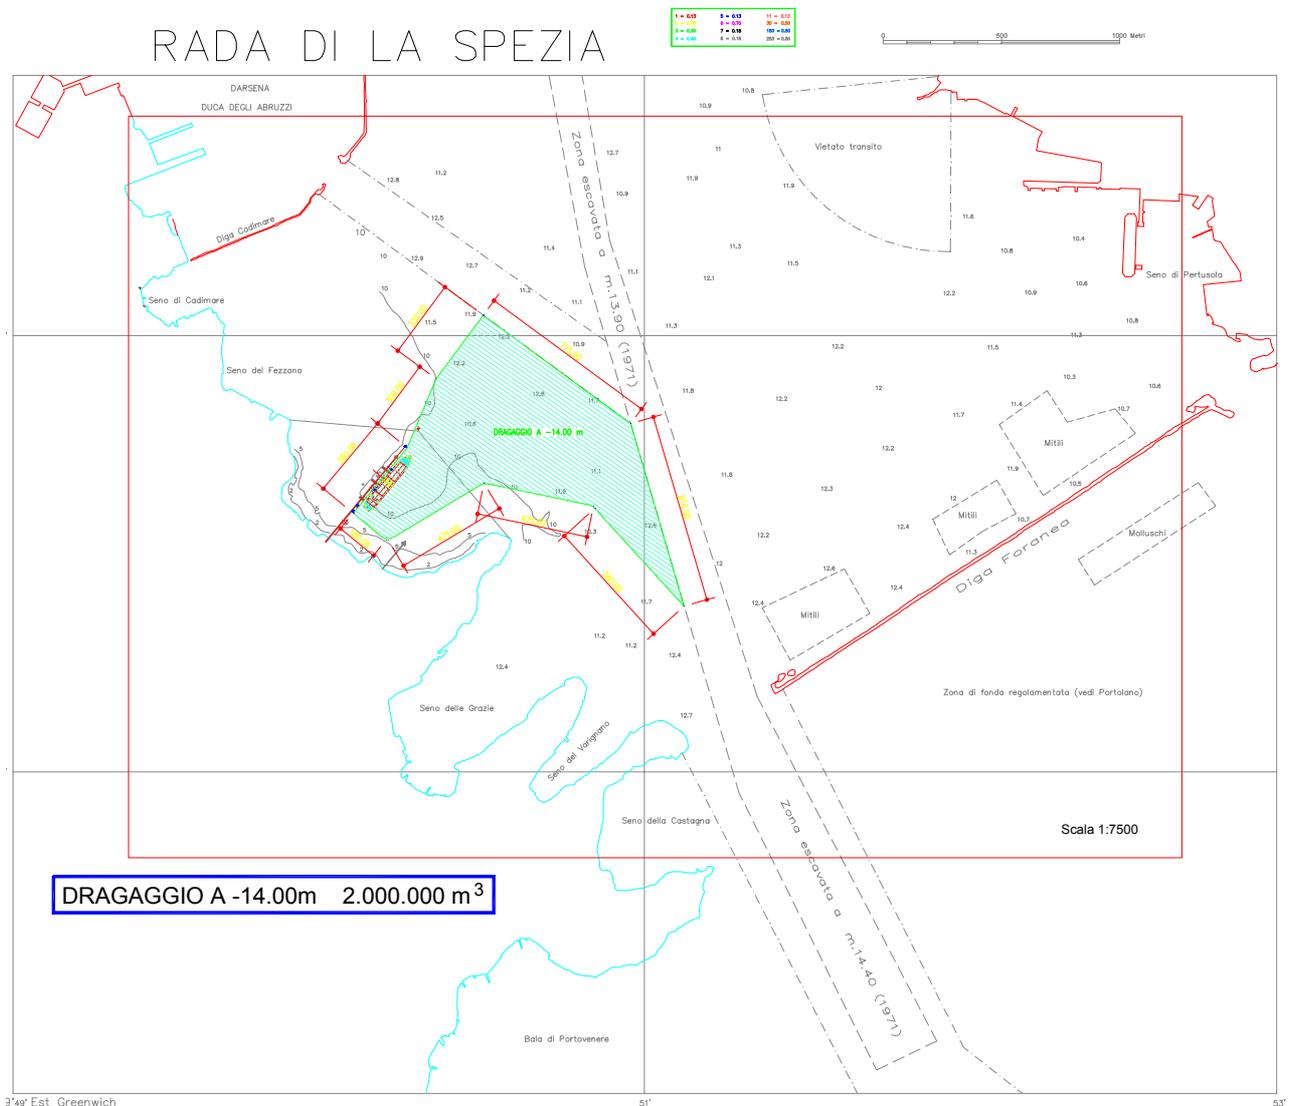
Area soggetta a dragaggio (-14 m)
